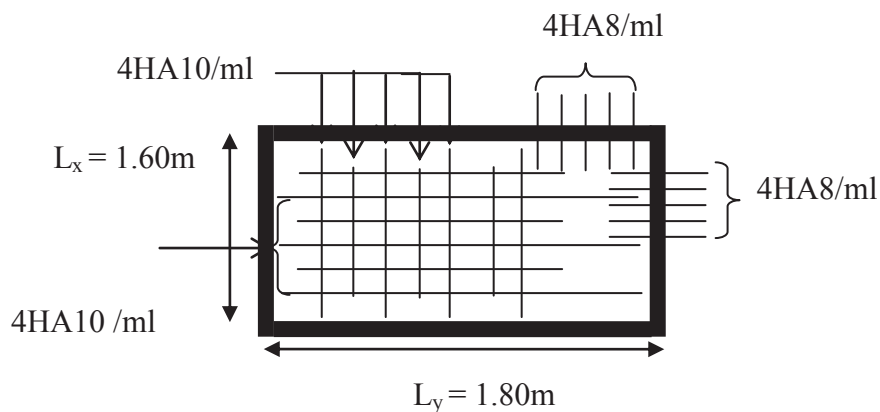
Schéma de ferrailage de la dalle au-dessus de l'ascenseur
